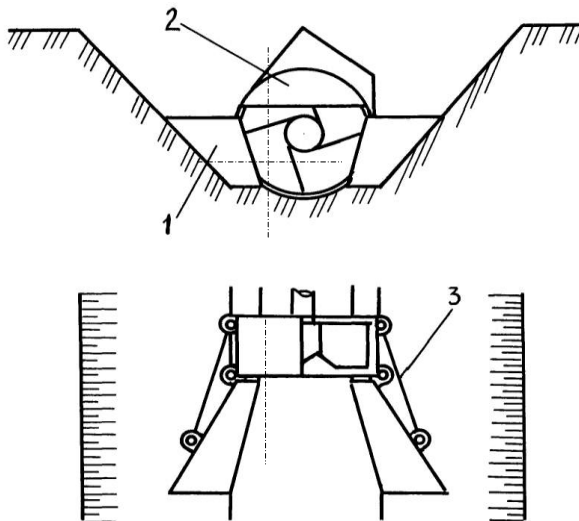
Схема фрезерного рабочего органа с открывками.
